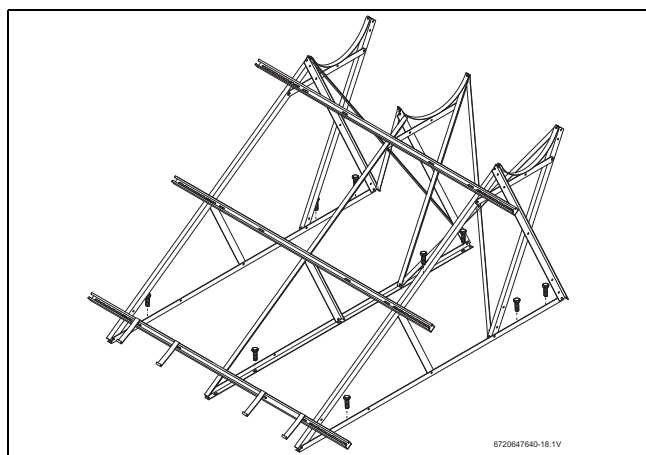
Soporte para tejado plano - anclaje directo en el tejado (sistema de 300 l)
